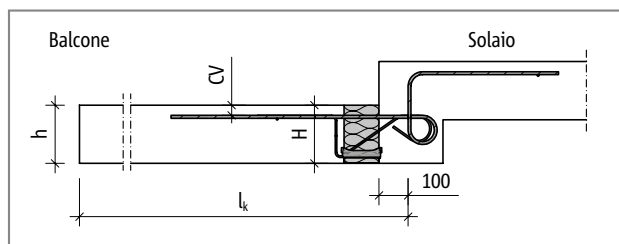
Schöck Isokorb® tipo KXT-HV: schema statico
